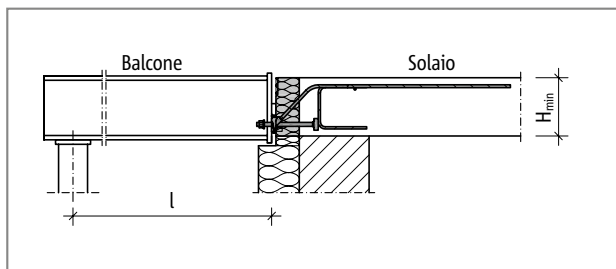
Schöck Isokorb® T tipo SQP: schema statico
